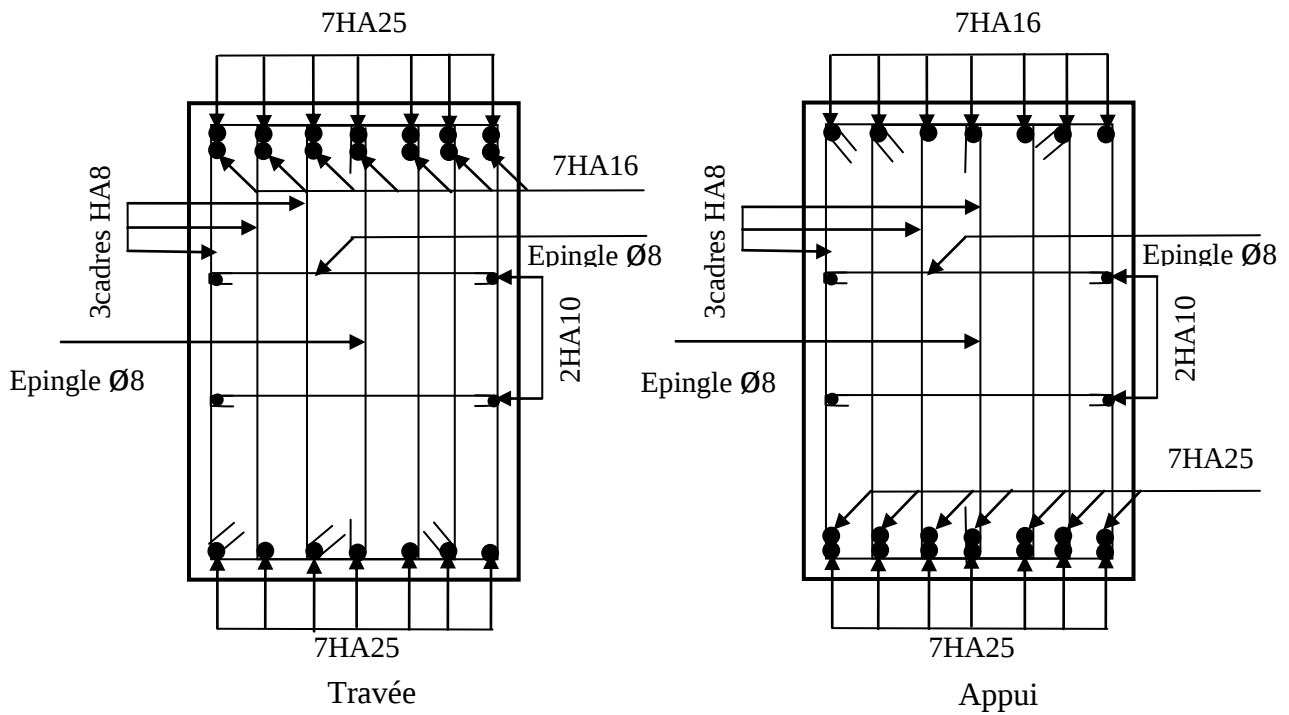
Schéma de ferrailage de la nervure sens yy
